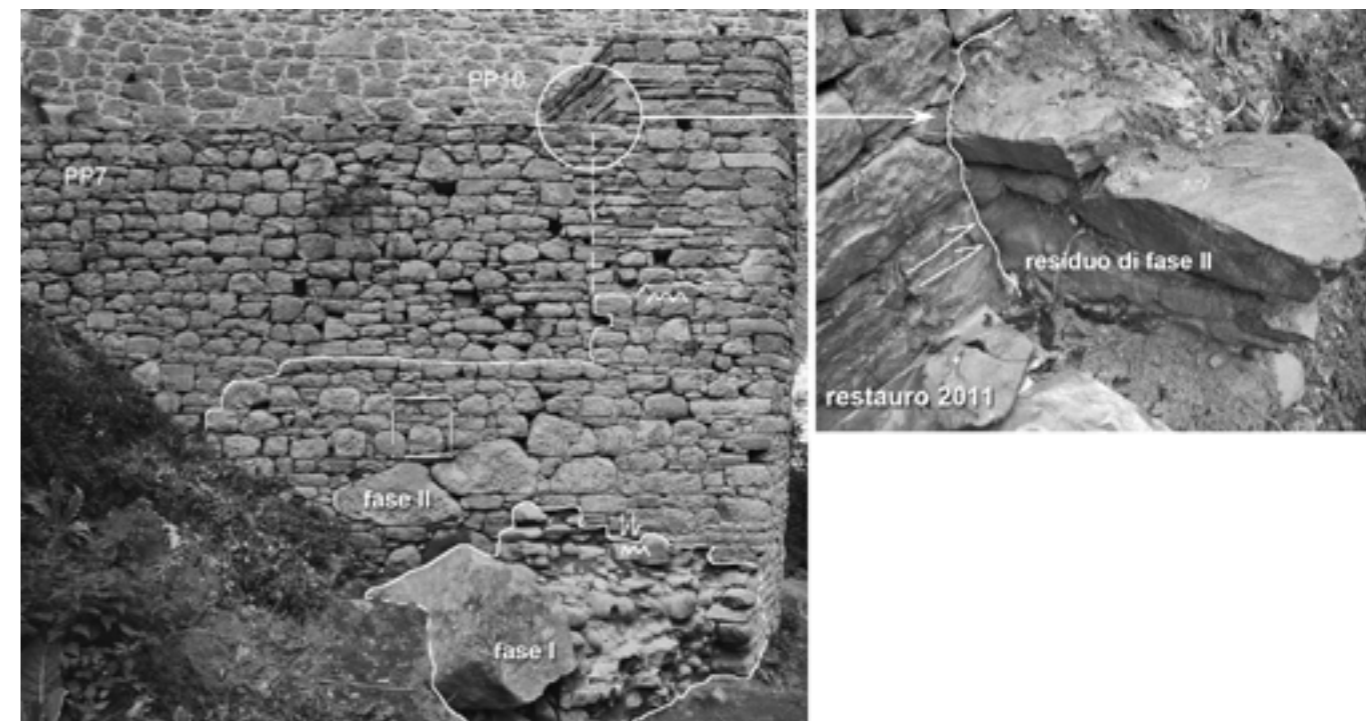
, Panoramica del muro di risvolta PP 7 con evidenziati i limiti delle strutture precedenti il ponte attuale: la sostruzione (fase I) e la muratura in appoggio ad essa (Fase II).
